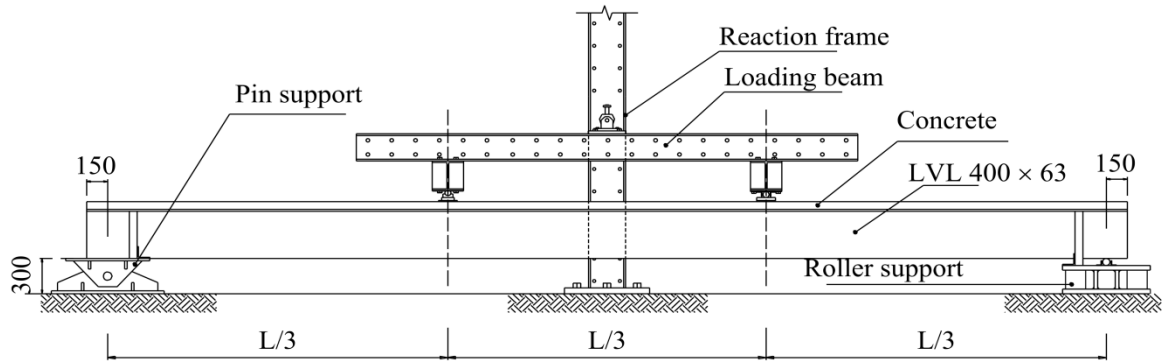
Essai de flexion à quatre points d'une poutre BBC (dimensions en mm) [4].
